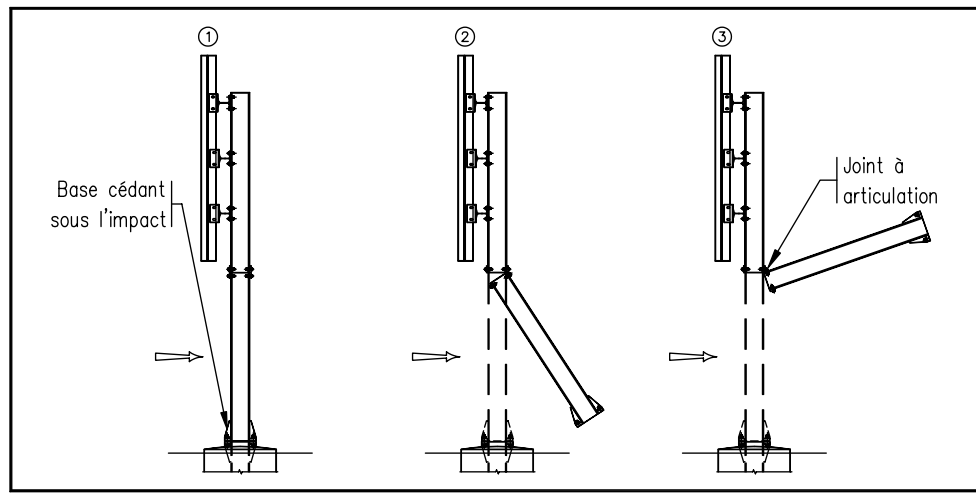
Fonctionnement d'une base à plan de glissement
